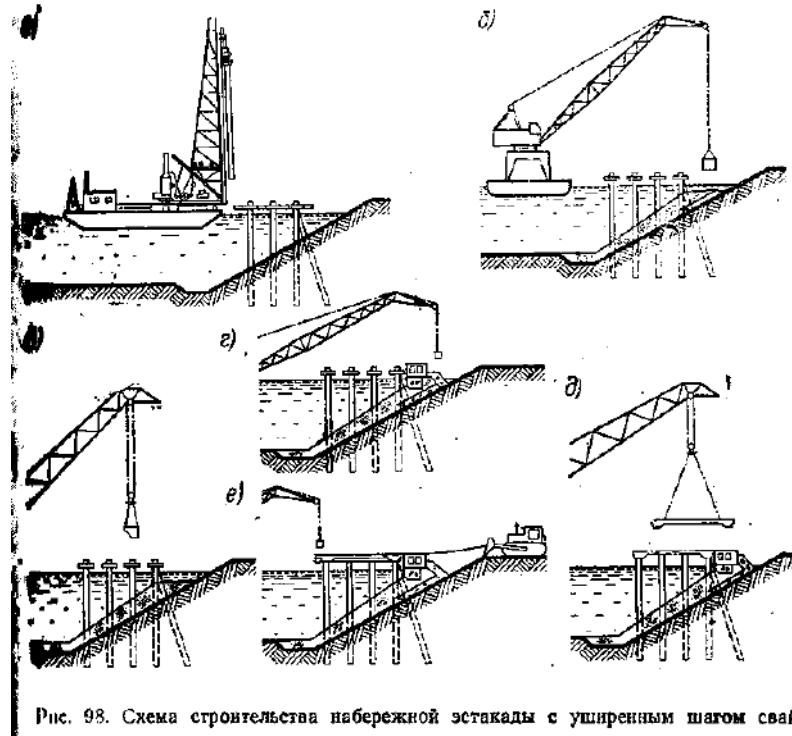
Схема будівництва набережної естакади з розширеним кроком паль
